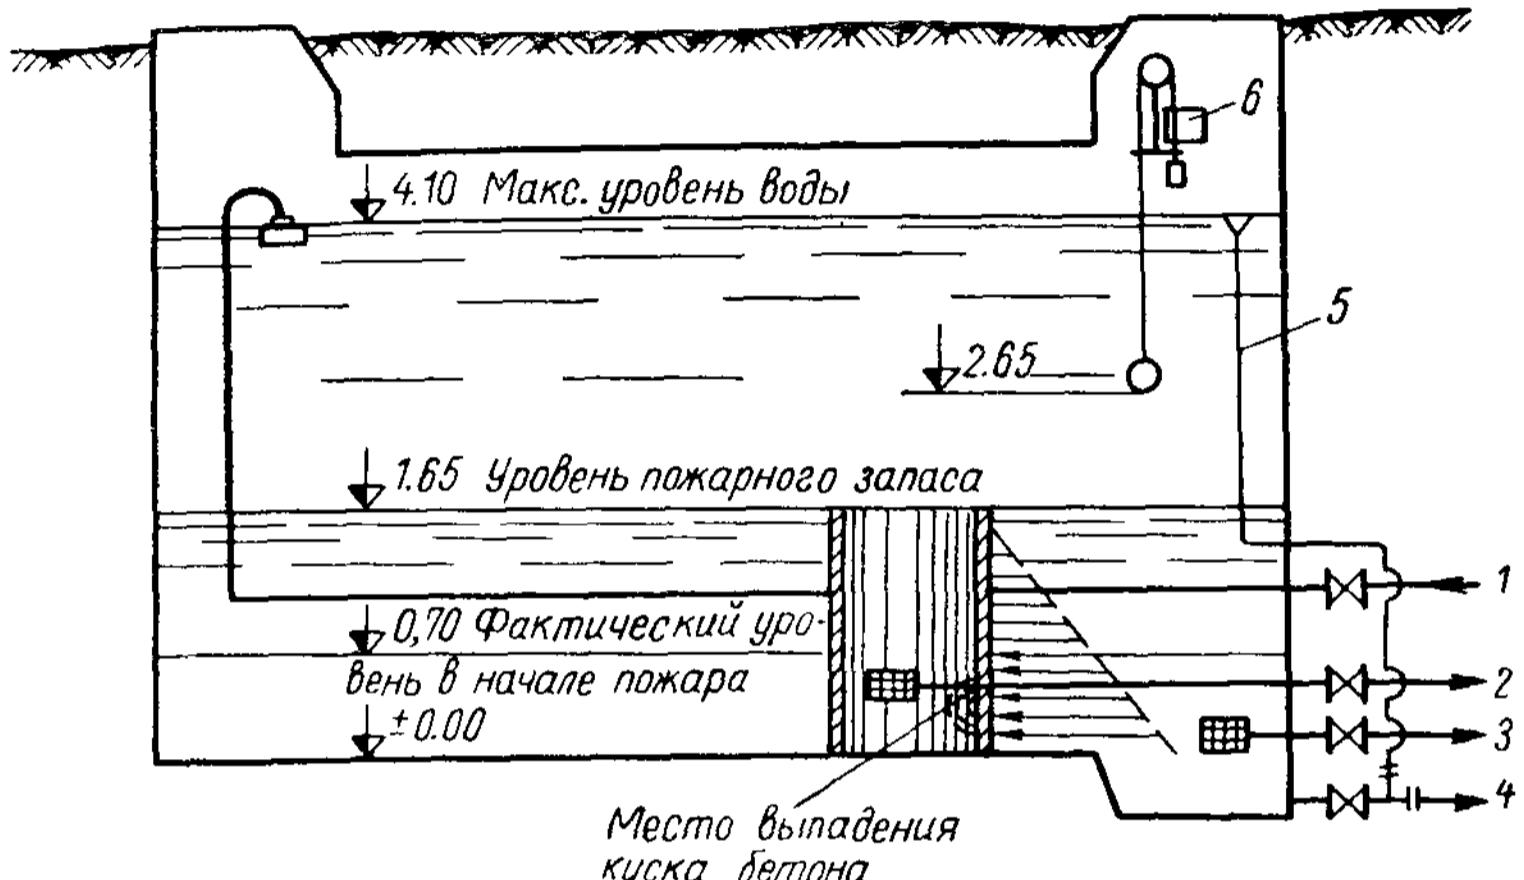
Схема сборного резервуара (к случаю с пожаром)
